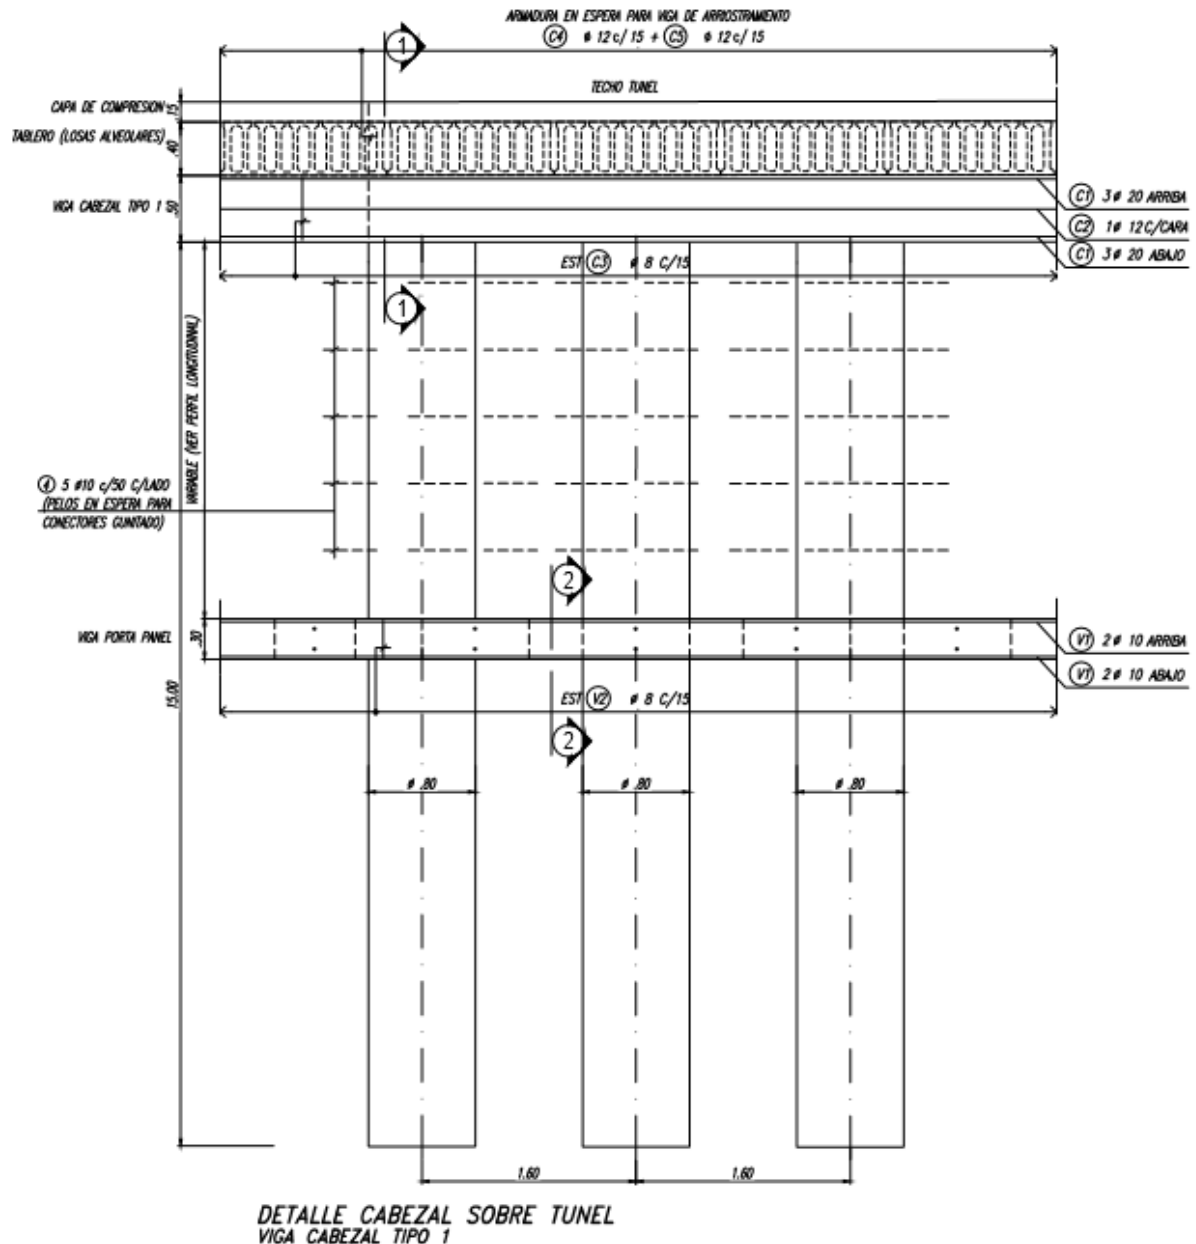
“Vista lateral de viga cabezal en zona interior de bajo nivel”
